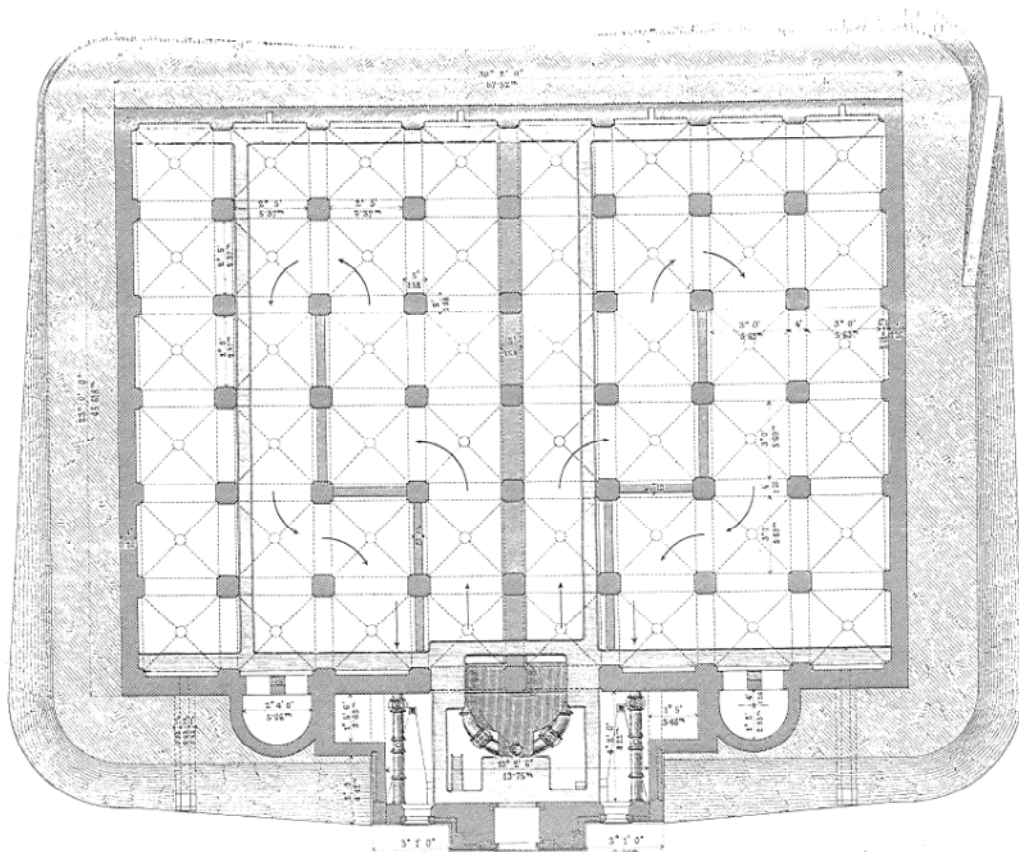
Grundriss der Speicherkammer des Wasserbehälters auf der Schmelz
